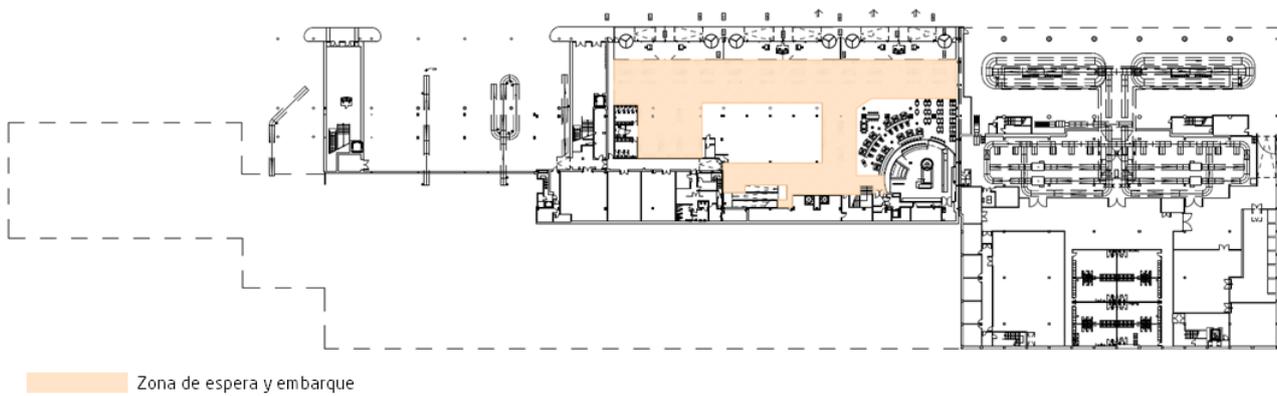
Planta P-1 del Edificio Terminal
